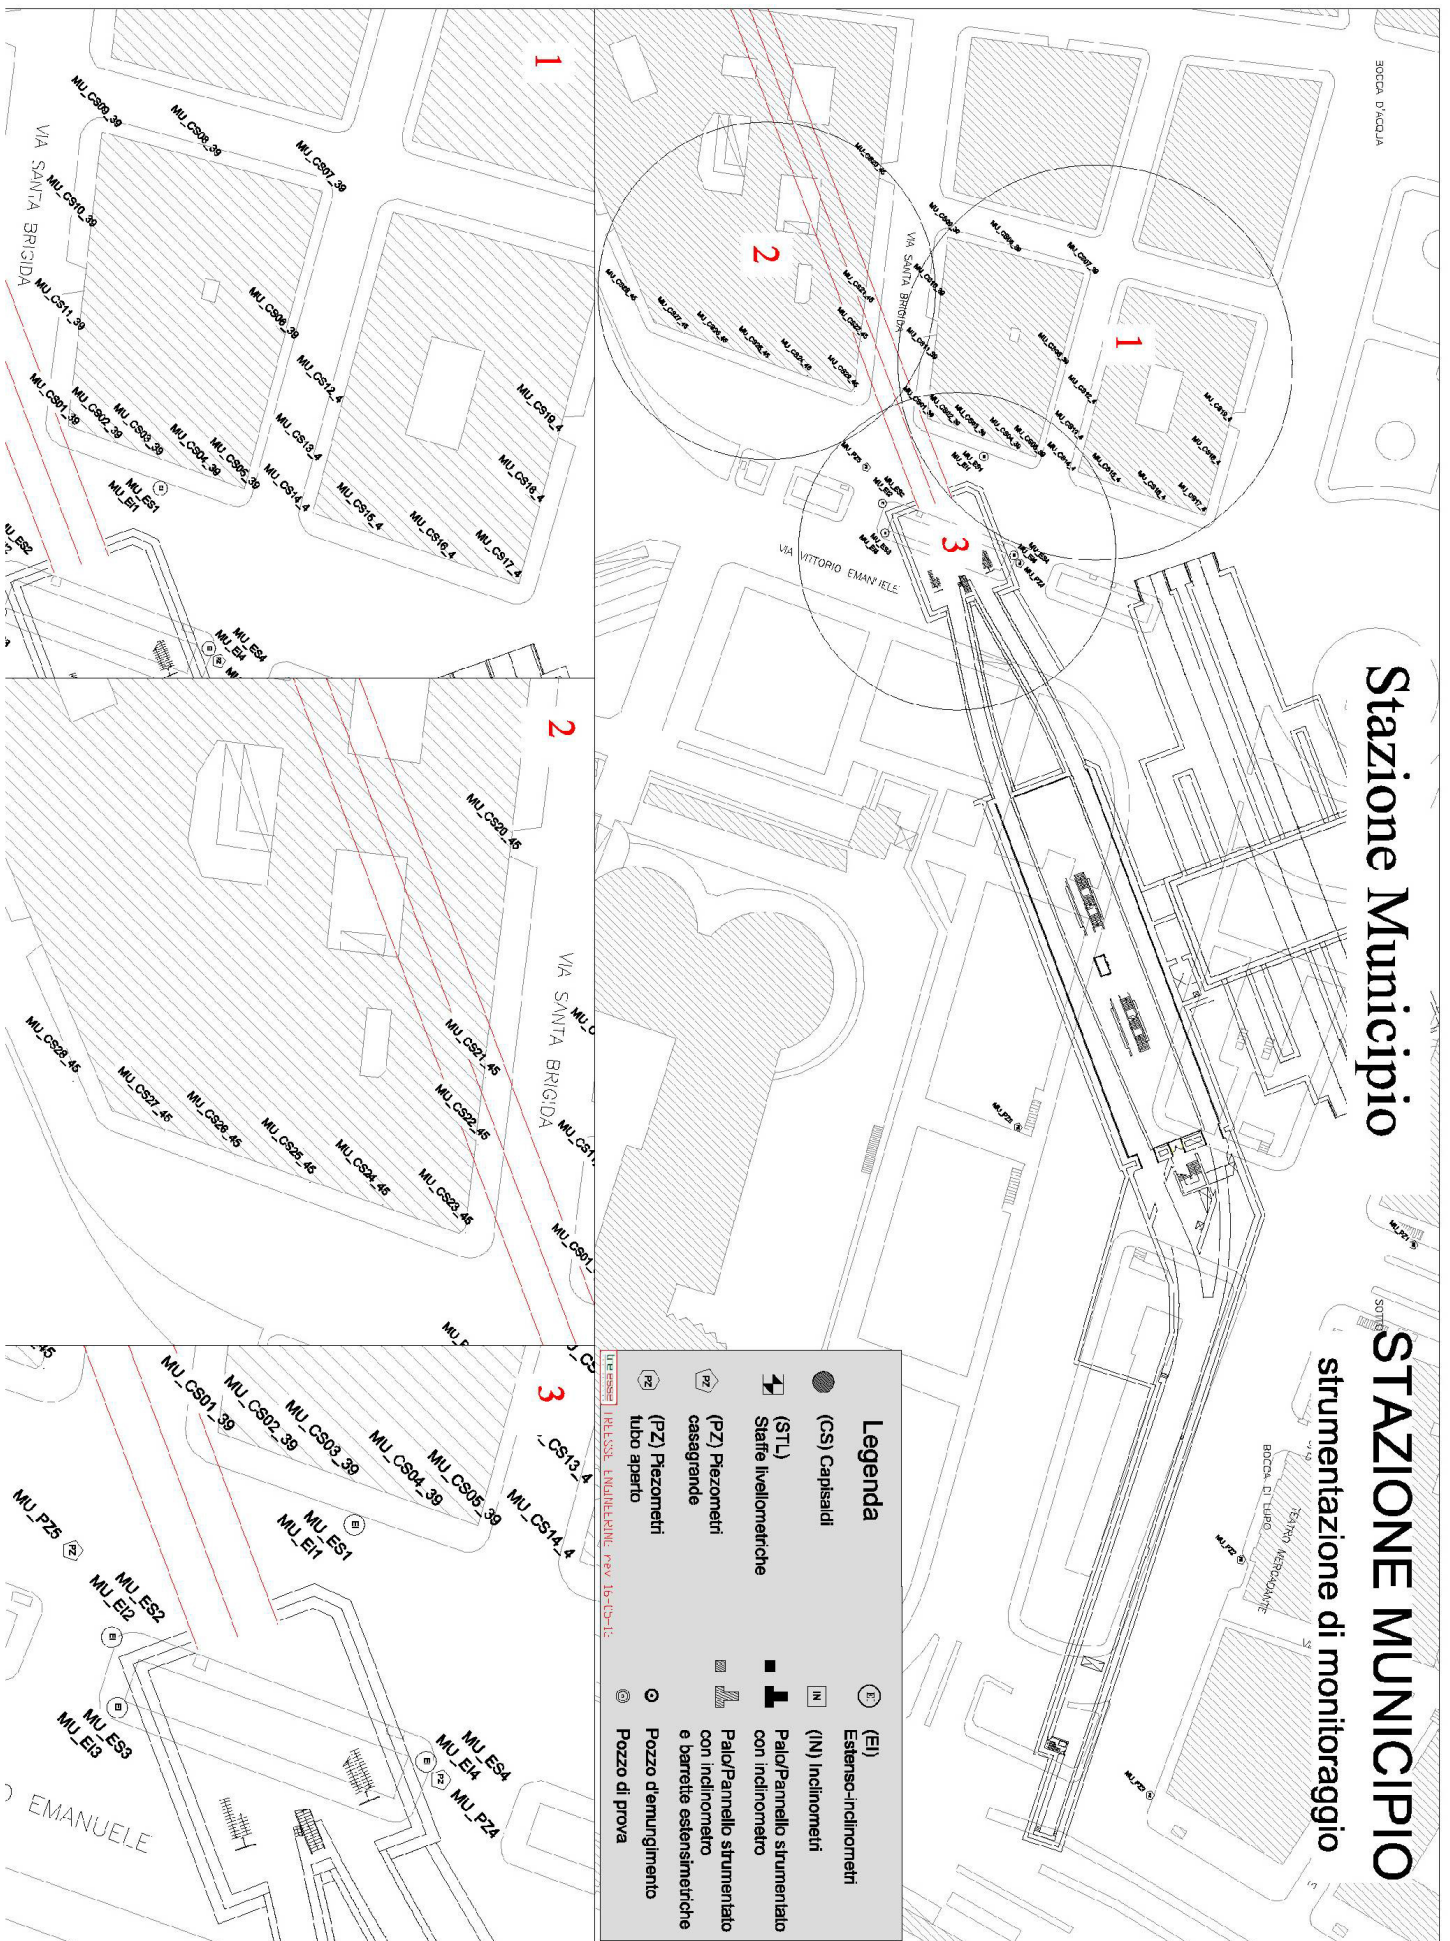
Planimetria pozzo stazione, raffigurante la disposizione della strumentazione di monitoraggio topografico e geotecnico esterna.
